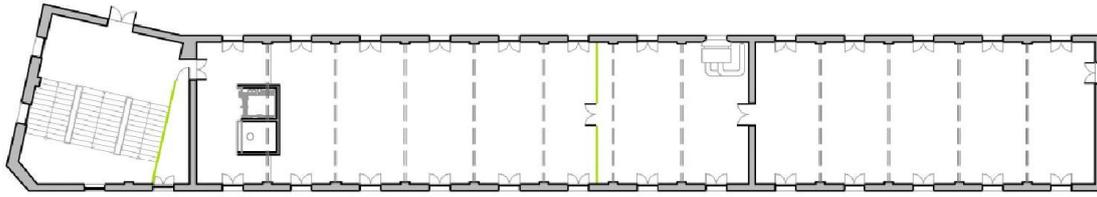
Imagen de la planta indicando los huecos.
